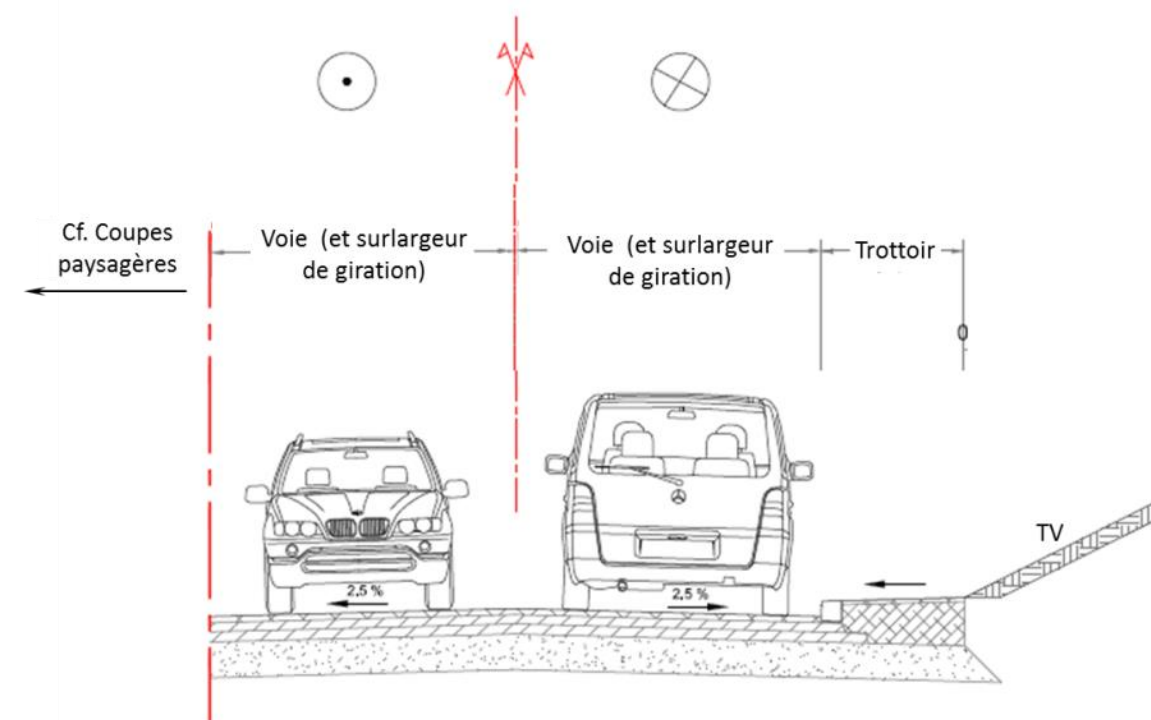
Profil en travers type mis en œuvre sur la route de Versailles (RD 446)
